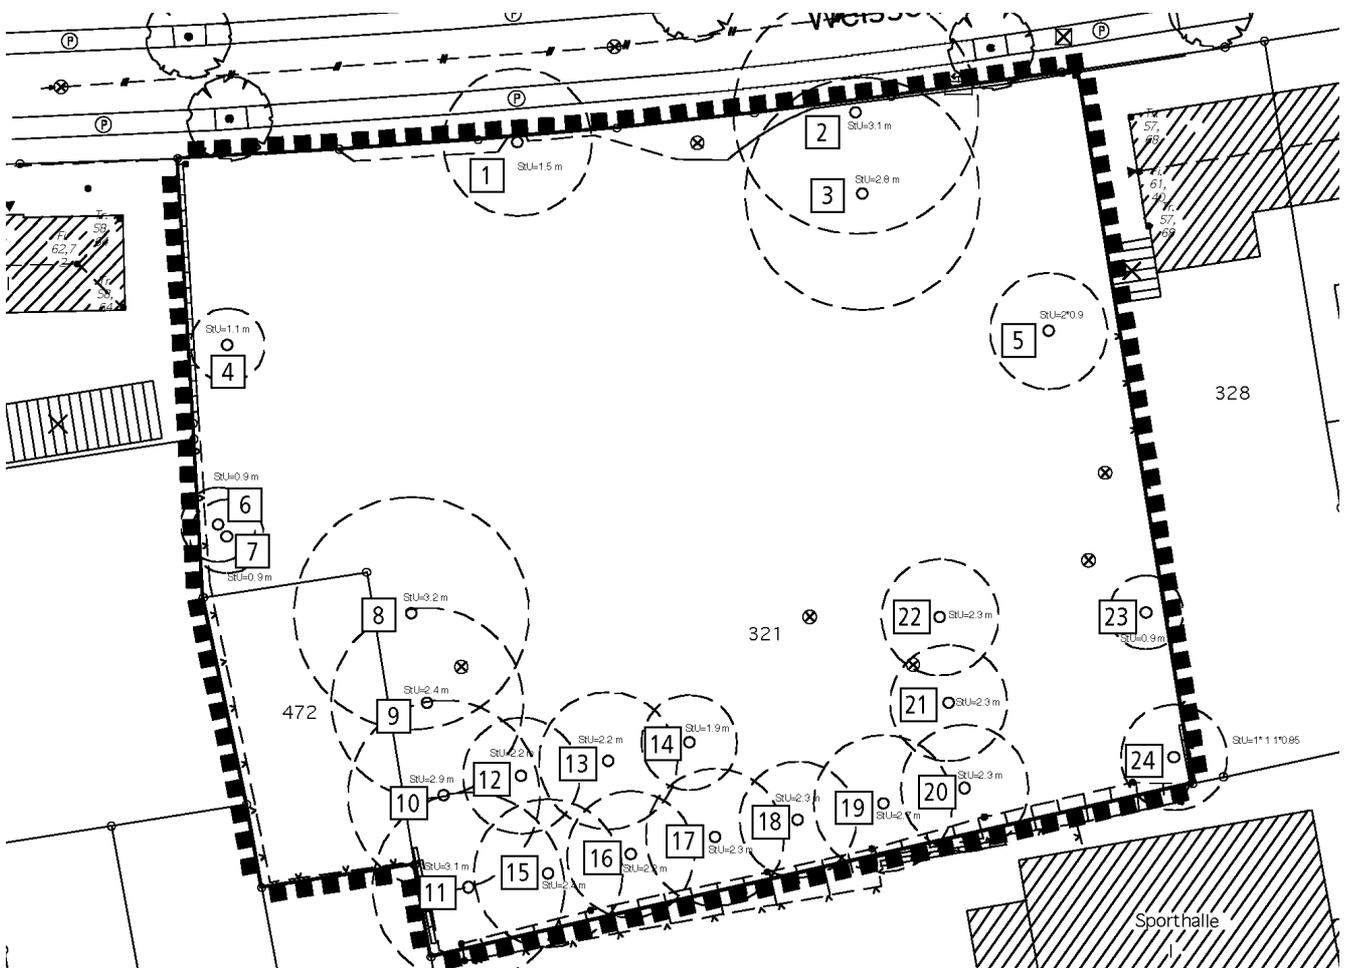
Lage der Baumstandorte im Plangebiet (unmaßstäblich)
